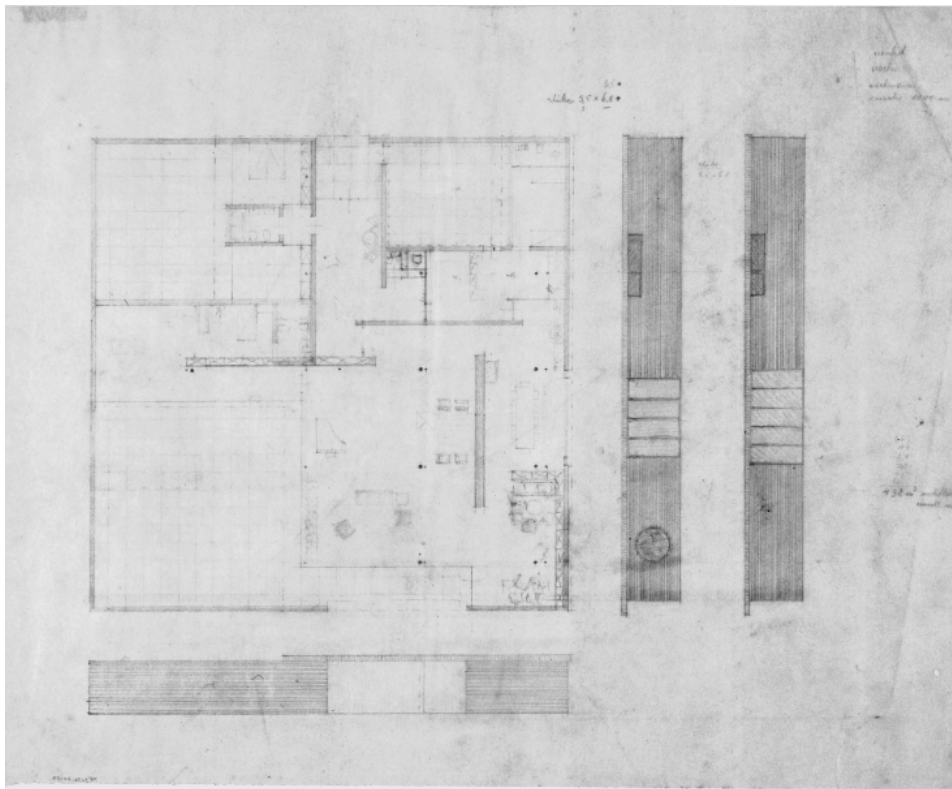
Planta baixa e elevações, Casa Hubbe, 1934
